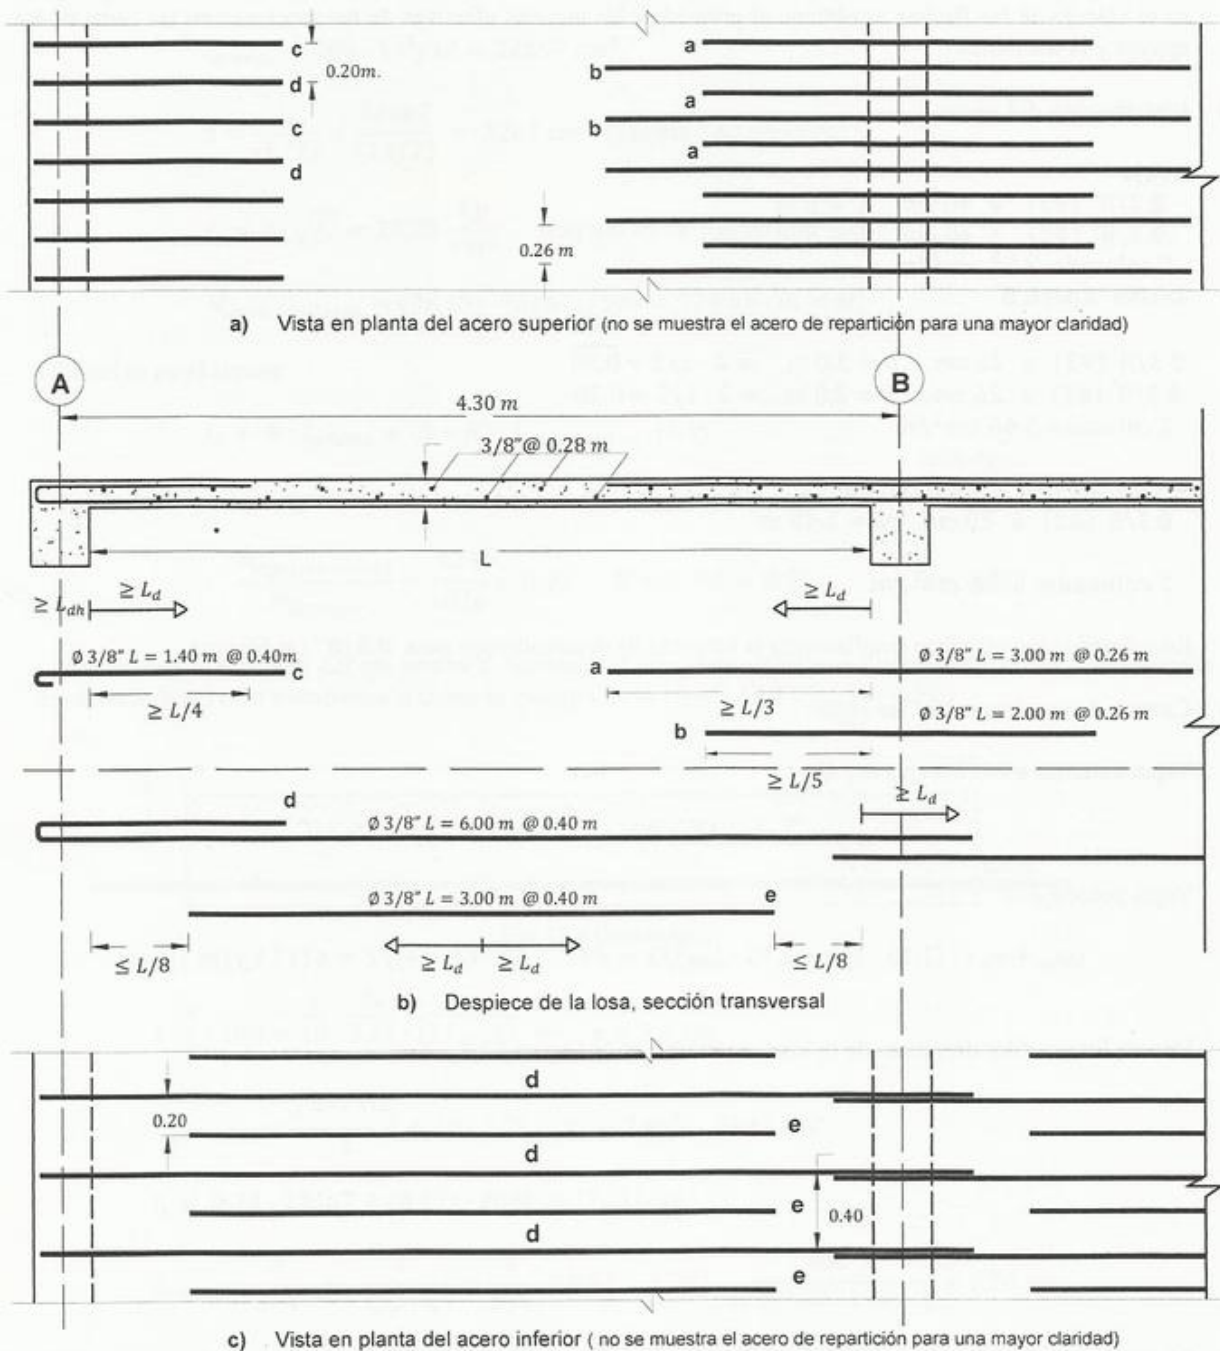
Despiece de la losa maciza (Ejemplo 12.1)
